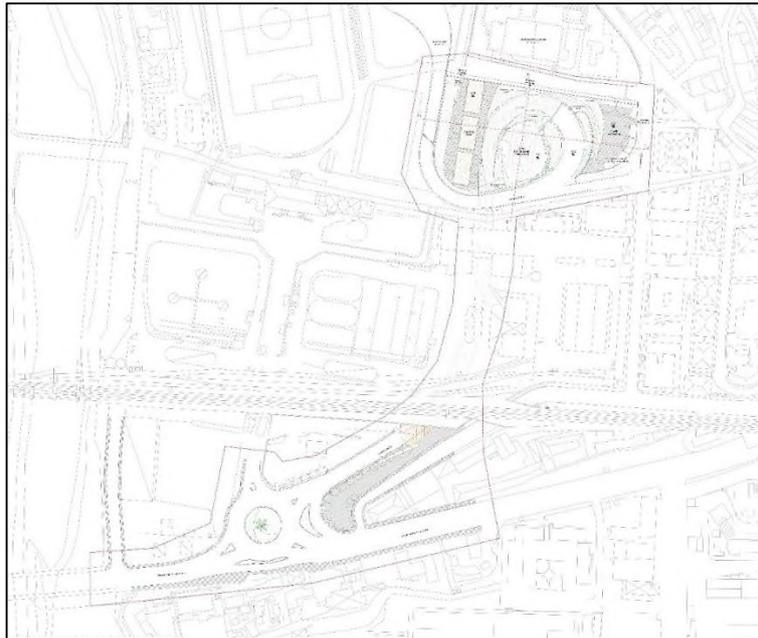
Planimetria di progetto con l'impronta di interferenza del cantiere
